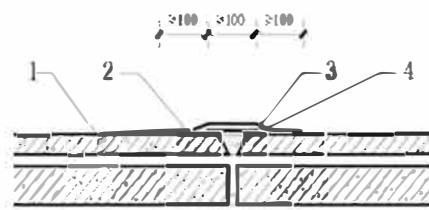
刚性混凝土防水层宽裂缝渗漏维修
